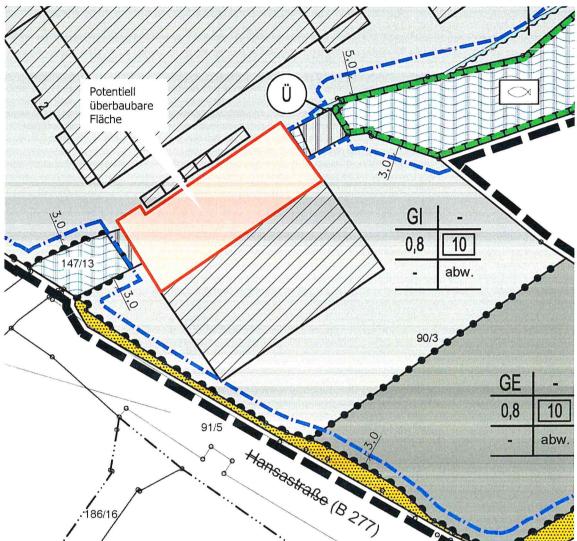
Ausschnitt B-Plan Nordöstlich der Hansastraße, Büro Zillinger, mit geplanter Halle
